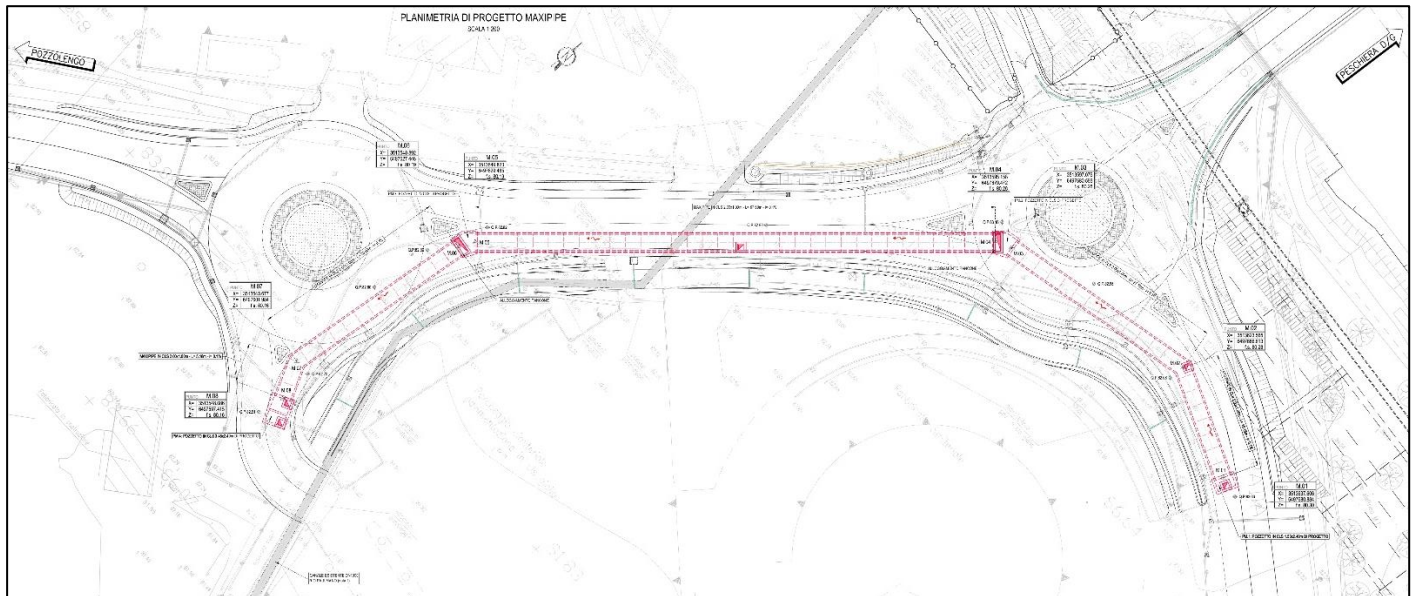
Estratto planimetria del collettore di laminazione delle acque meteoriche dell'intervento in progetto
